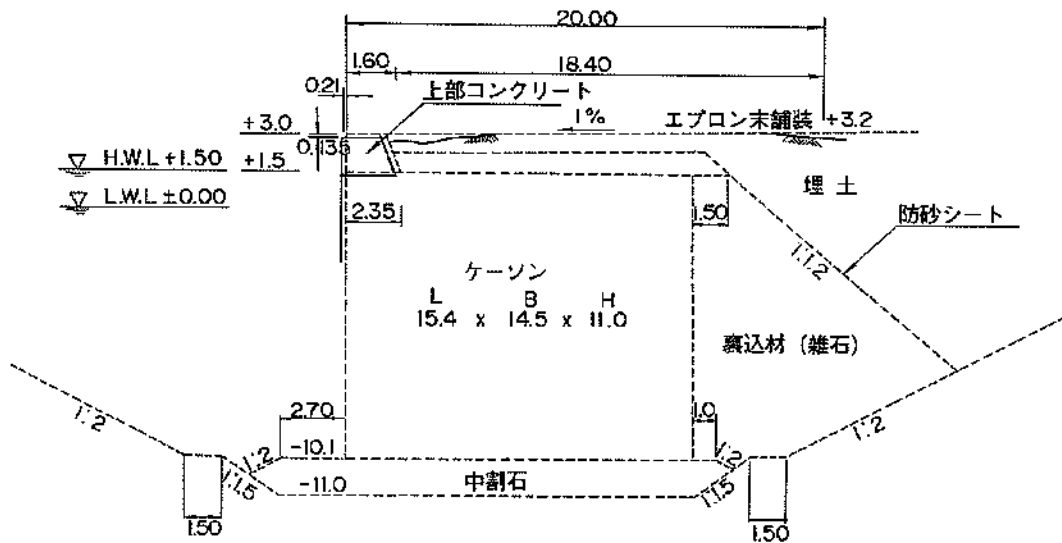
標準断面図・被災変形図 (第3埠頭地区, ⑦西側岸壁(-10.0m))
